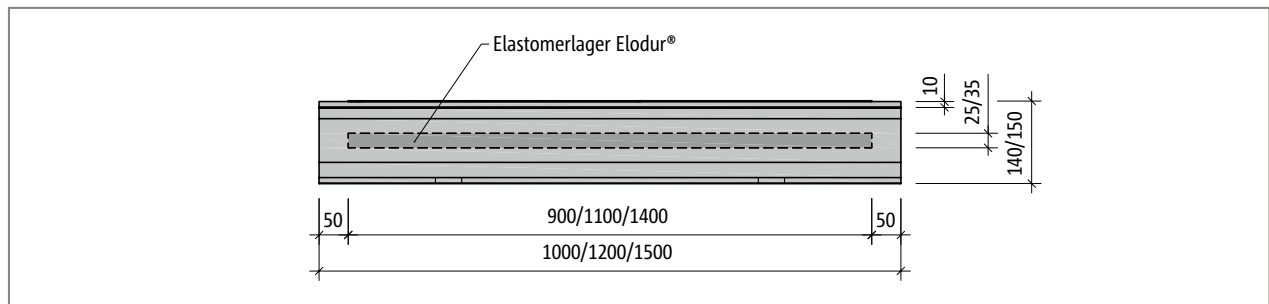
Schöck Tronsole® Typ BZ: Grundriss
